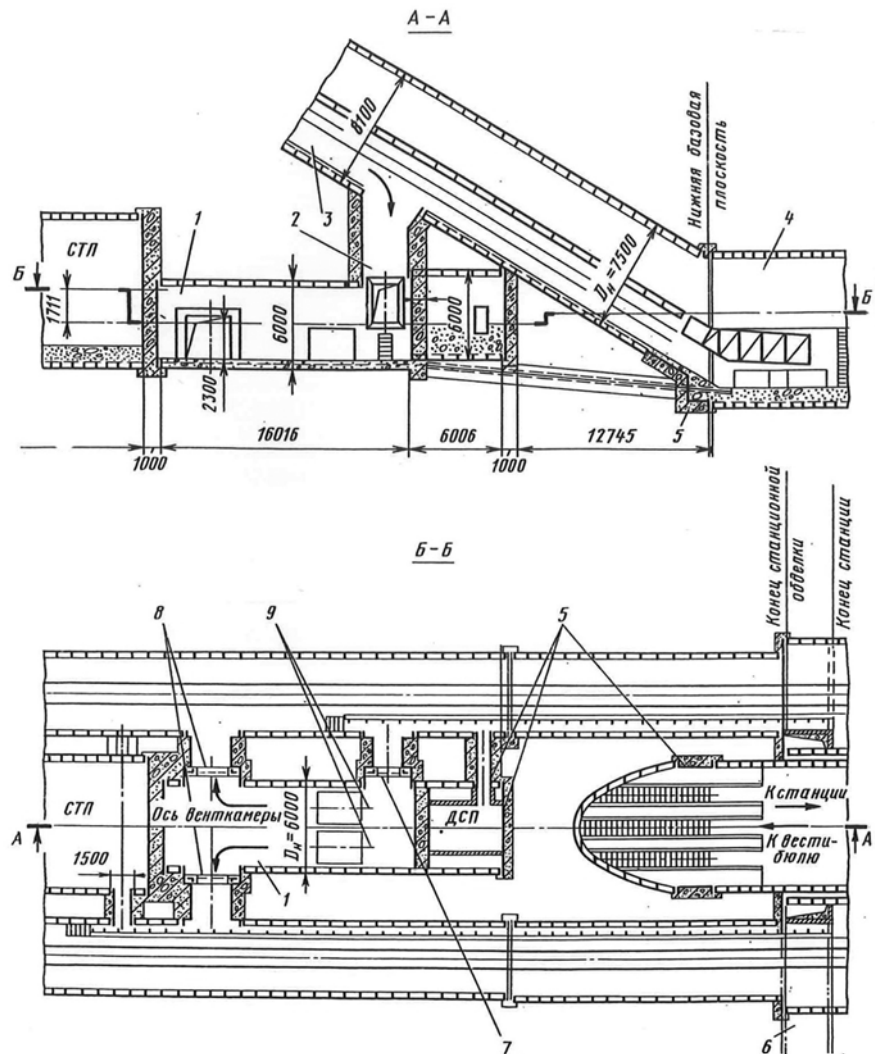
Сопряжение станционной вентиляционной камеры с вентиляционной шахтой и СТП при вентиляции через эскалаторный тоннель: 1 — станционная вентиляционная камера; 2 — вентиляционная шахта; 3 — монтажные балки; 4 — натяжная камера; 5 — металлическая гидроизоляция; 6 — кабельный коллектор; 7, 8 — обрамления для затвора ЗТ-98; 9 — вентиляторы
